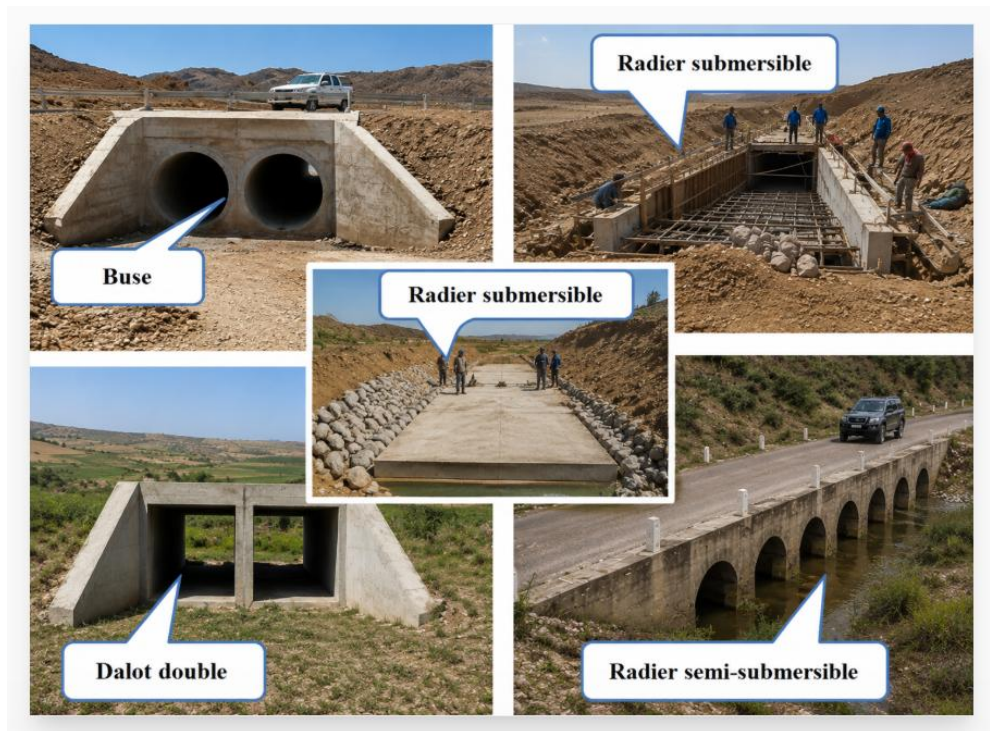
Exemple d'un ouvrage de franchissement
